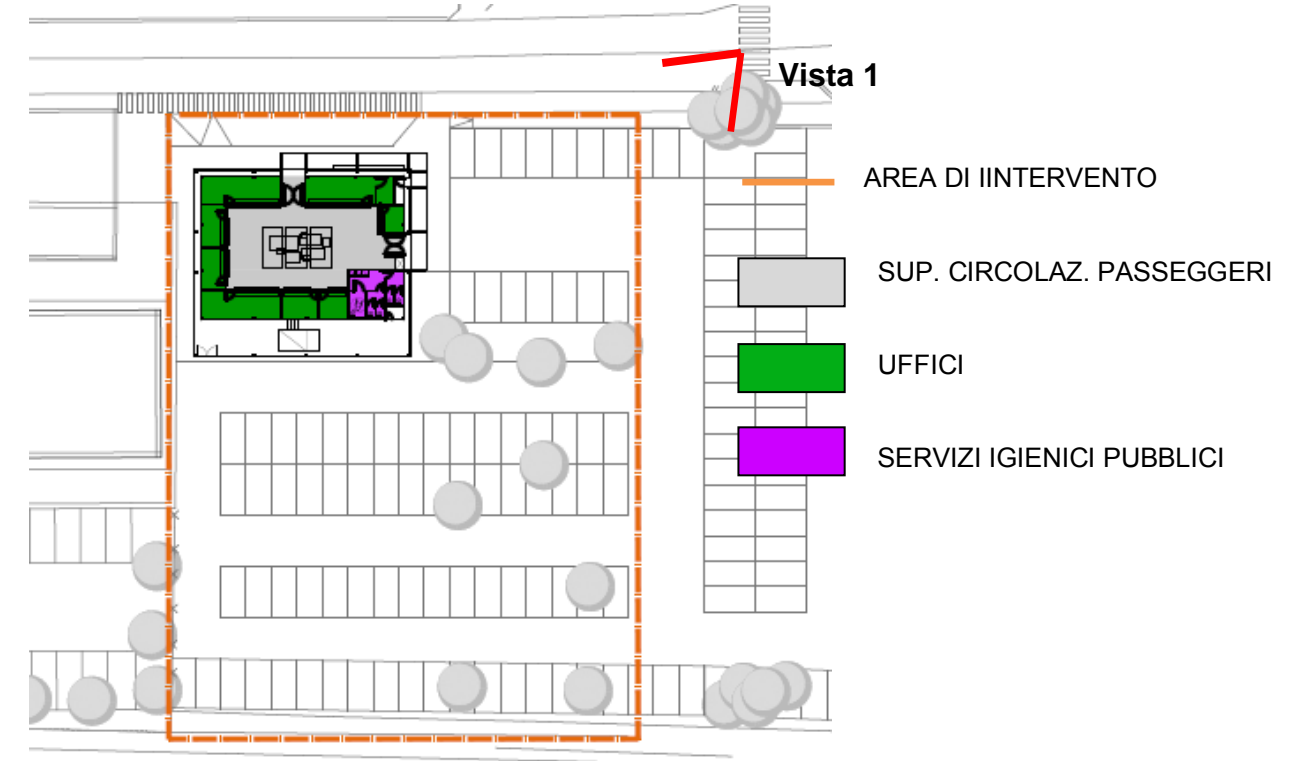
EDIFICIO RENT A CAR : PLANIMETRIA GENERALE
